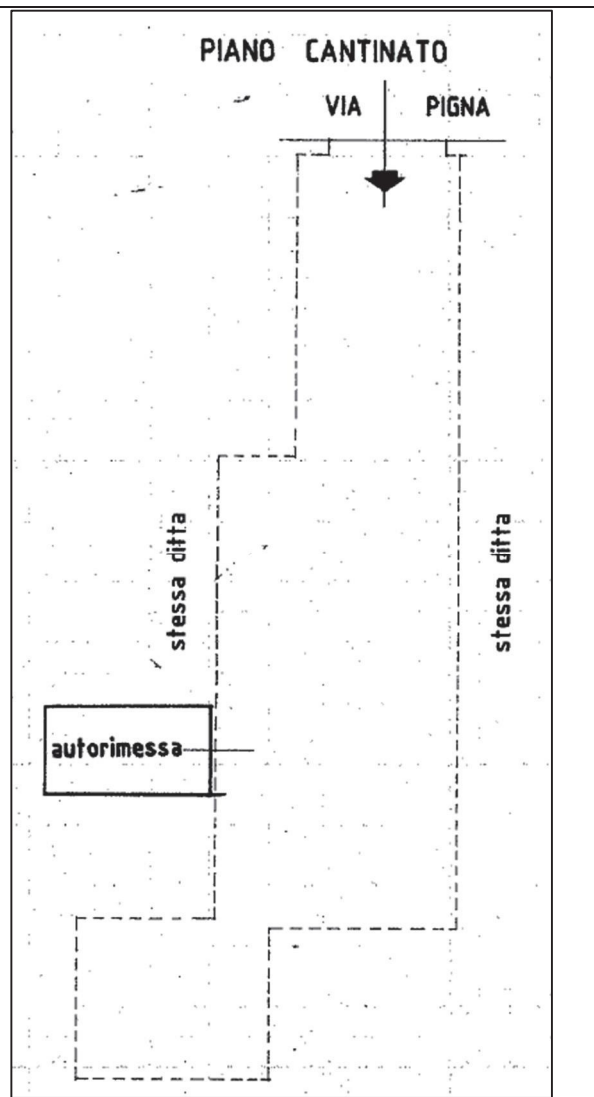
planimetria catastale dell'autorimessa identificata con la particella 98 sub 24
